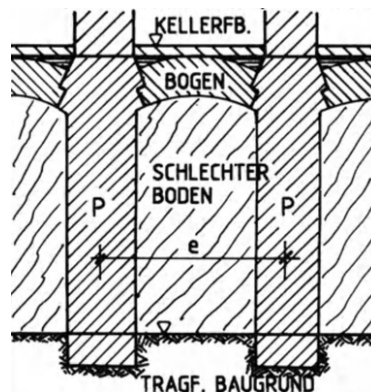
Pfeilerfundament (aus Bruchsteinmauerwerk und Stampfbeton)/Angaben um 1900 [15]
